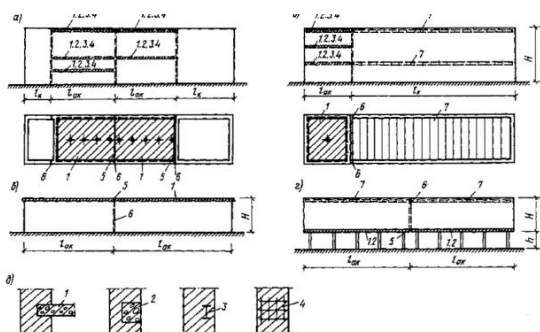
Примеры устройства температурных швов в стенах каменных зданий с армированными включениями (перекрытия, балки, армированные пояса): *а* – при расположении армированных включений в средней части здания; *б* – то же, в крайней части; *в* – при железобетонном покрытии (крыше) со швом; *г* – при фундаментных балках со швом; *д* – примеры заделки армированных включений в кладку стен; 1 – перекрытие; 2 – железобетонная балка; 3 – металлическая балка; 4 – арматура; 5 – температурный шов в армированных элементах (плитах, балках); 6 – то же, в каменных стенах (пунктир); 7 – сборные перекрытия с поперечными швами
